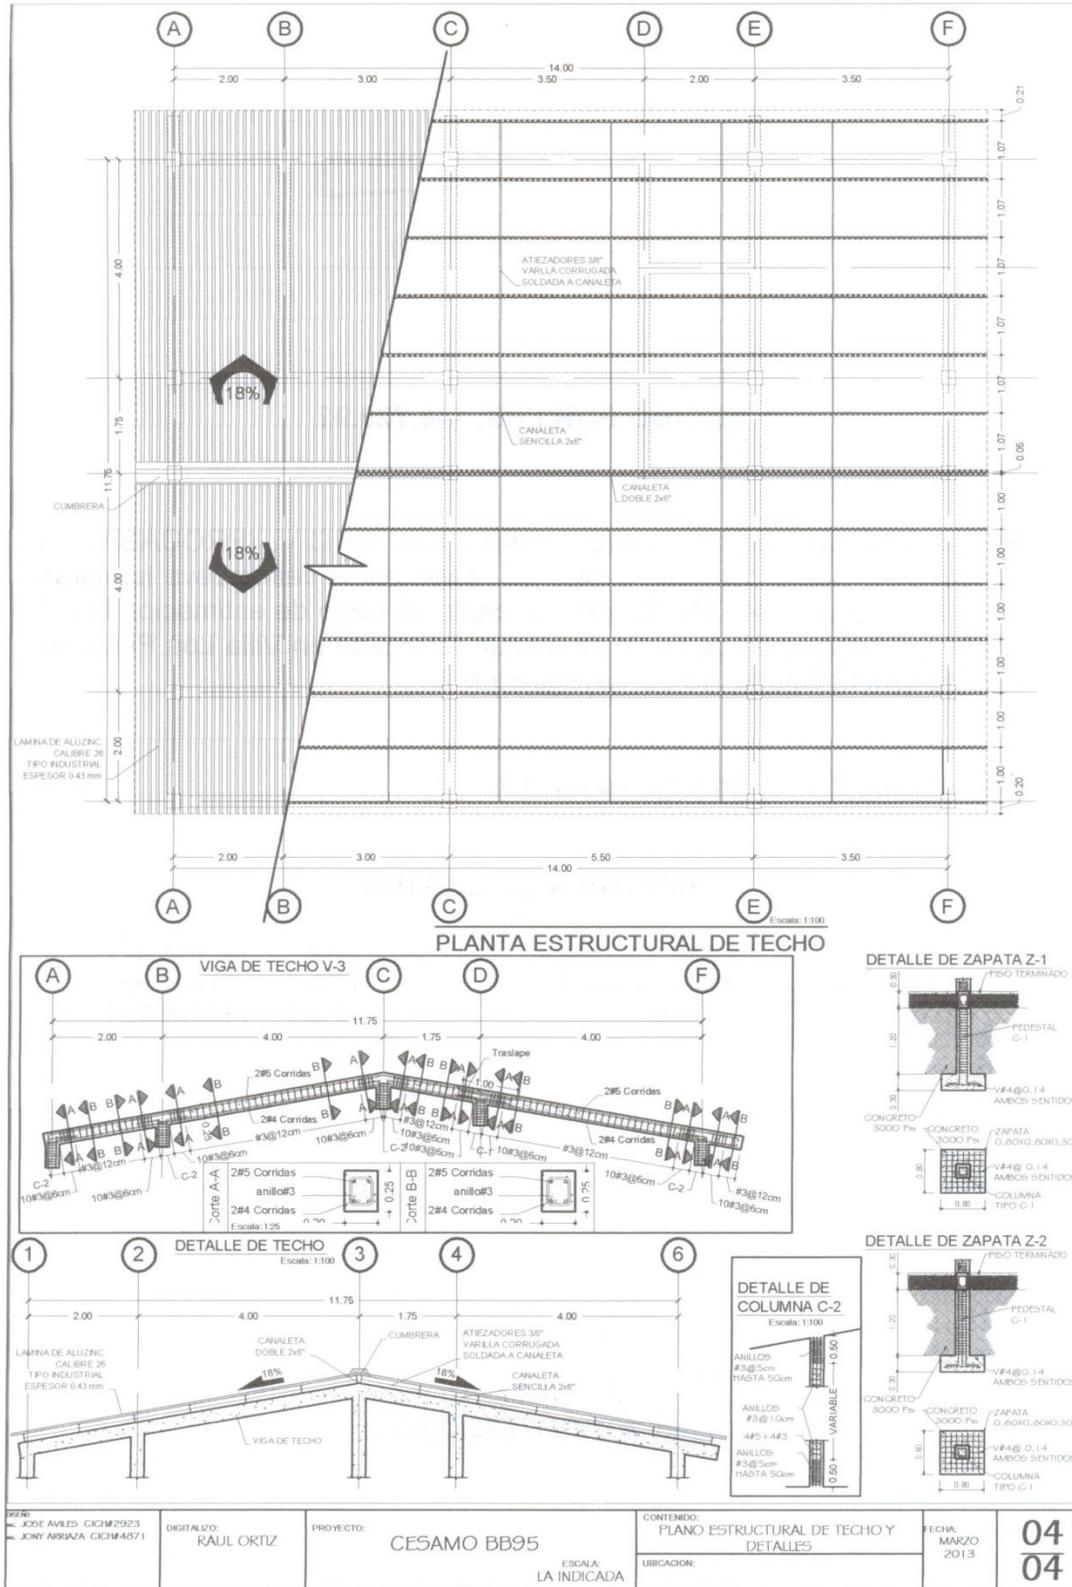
Plano Estructural de Techo CESAMO Tipo I Nivel 12X14m
